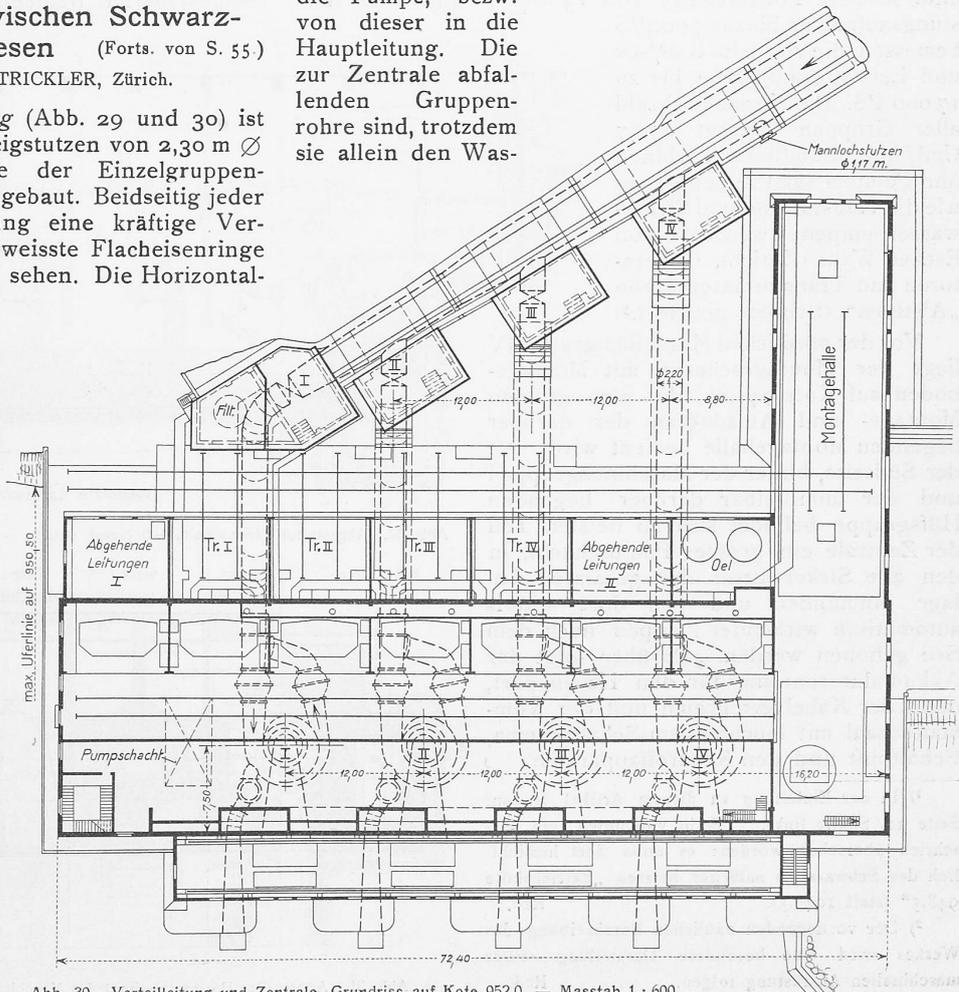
Verteilung und Zentrale, Grundriss auf Kote 952,0. — Masstab 1 : 600.
